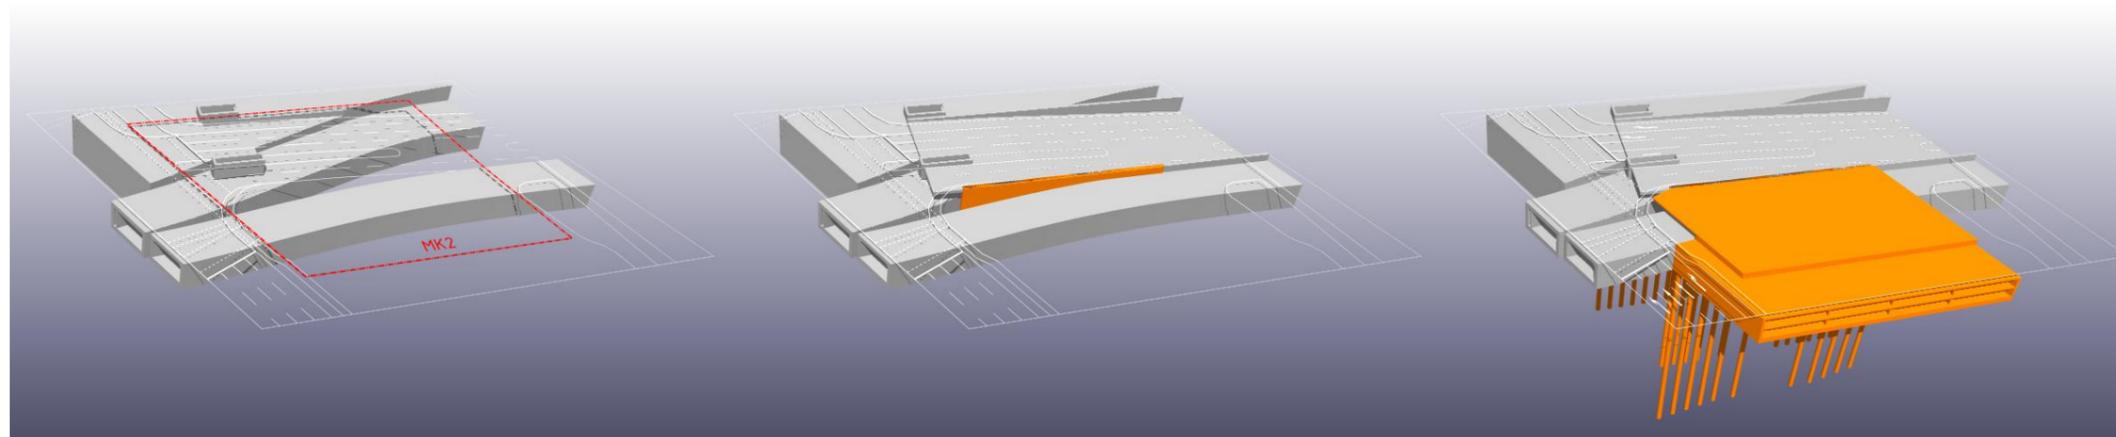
Unterbauung des Baufeldes: Tiefgarage Lehrter Bahnhof, Tunnelröhren der B96 Abb. II.7 Lage der Rampe des B96-Tunnels und der lastabtragenden Wandscheibe W2 Abb. II.8 Fundamentplatte, Anschnitt Tiefgarage mit vorgesehener Tiefgründung
